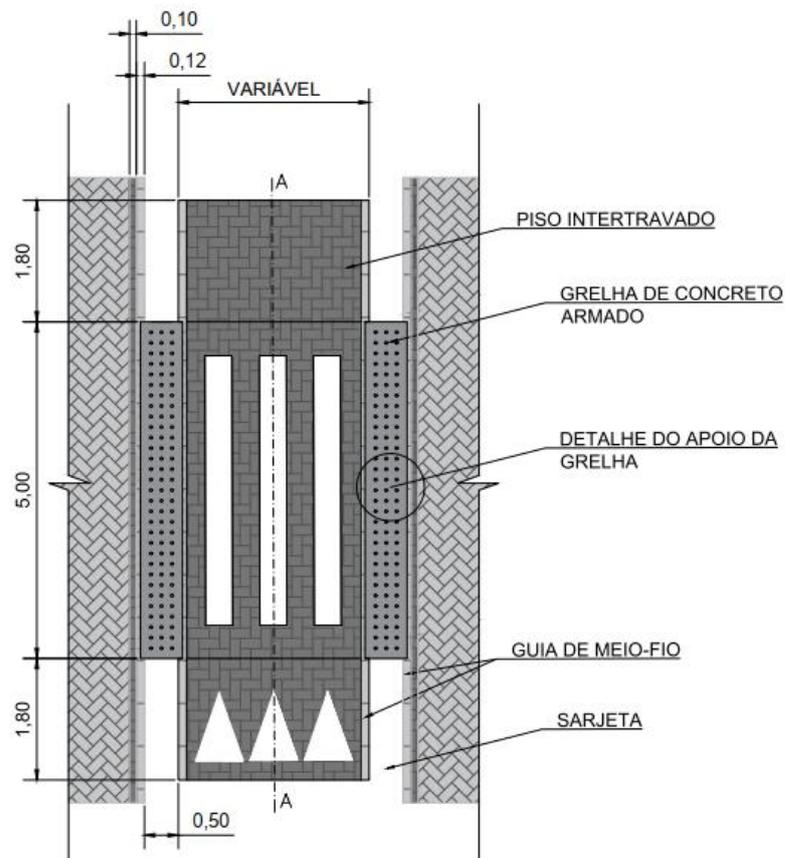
Detalhamento da faixa de pedestre elevada – vista superior
